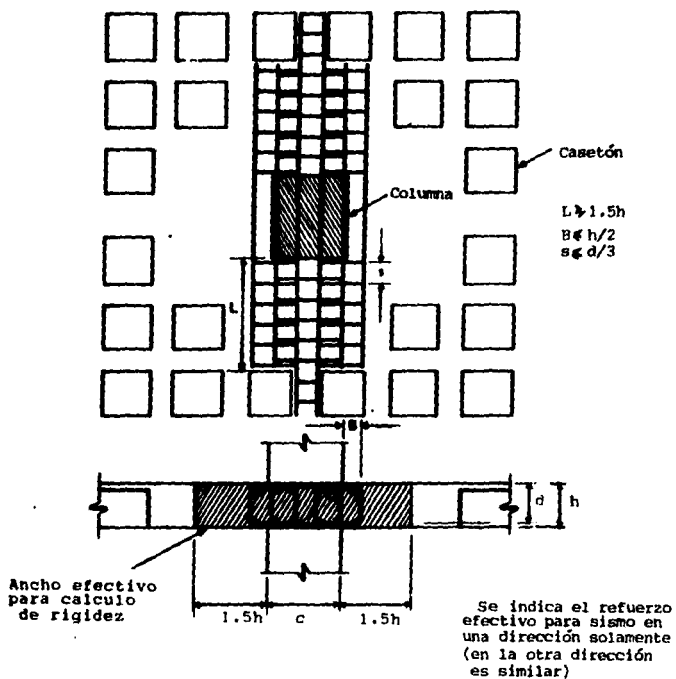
Refuerzo en la conexión losa plana-columna.
